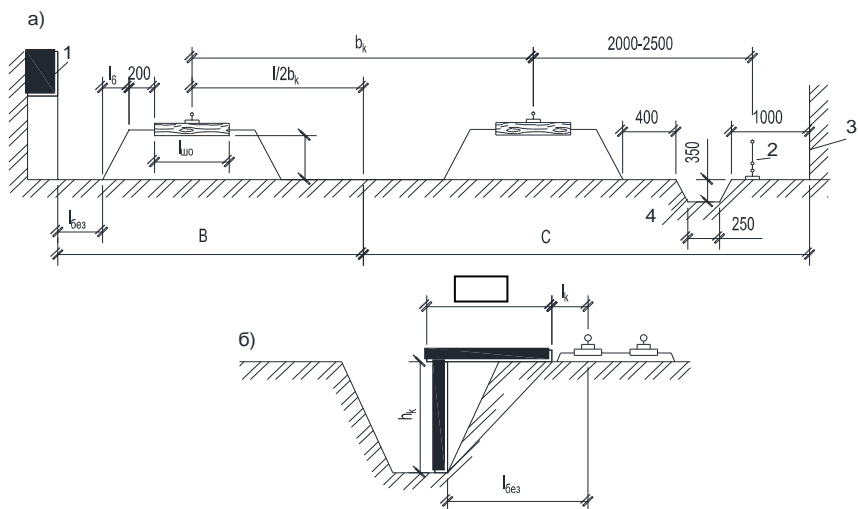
Схема поперечной привязки подкрановых путей:
